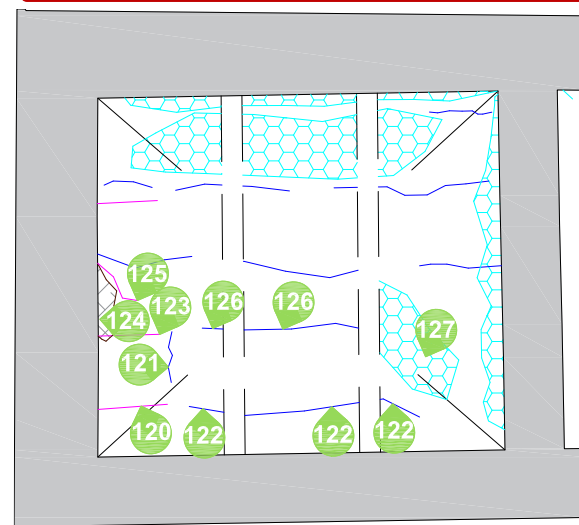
Vegetación parásita y fisuras principales deterioros
